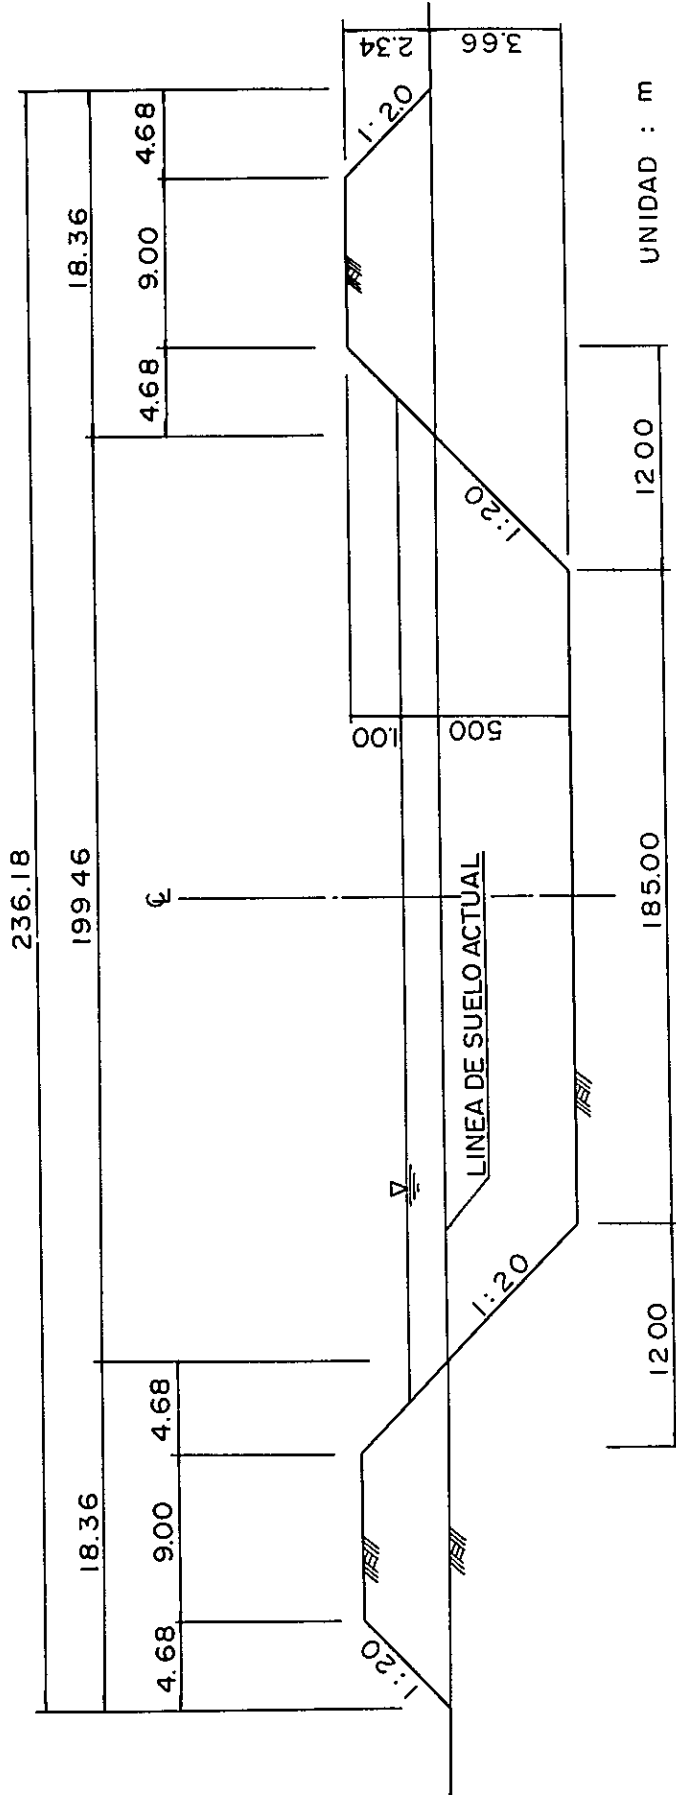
SECCIÓN NORMAL DEL CANAL DE ATAJE
